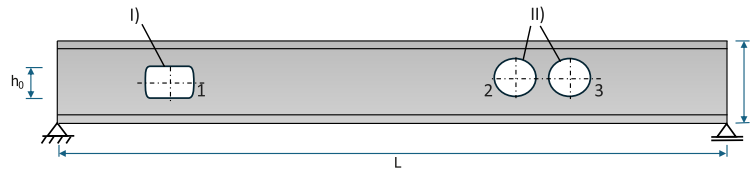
Aufbau des Stahlträgers mit: I) einer rechteckigen Stegöffnung (links) und II) zwei eng beieinanderliegende runde Stegöffnungen (rechts).
